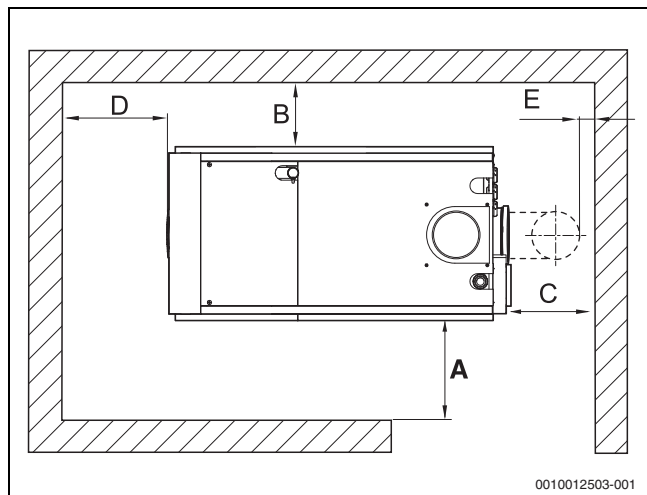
Distanze dalle pareti nel locale di posa (versione destra, caldaia singola)
